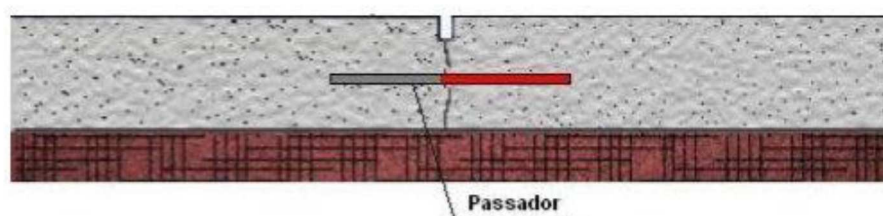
Laje de betão com passador (OLIVEIRA, 2000)
